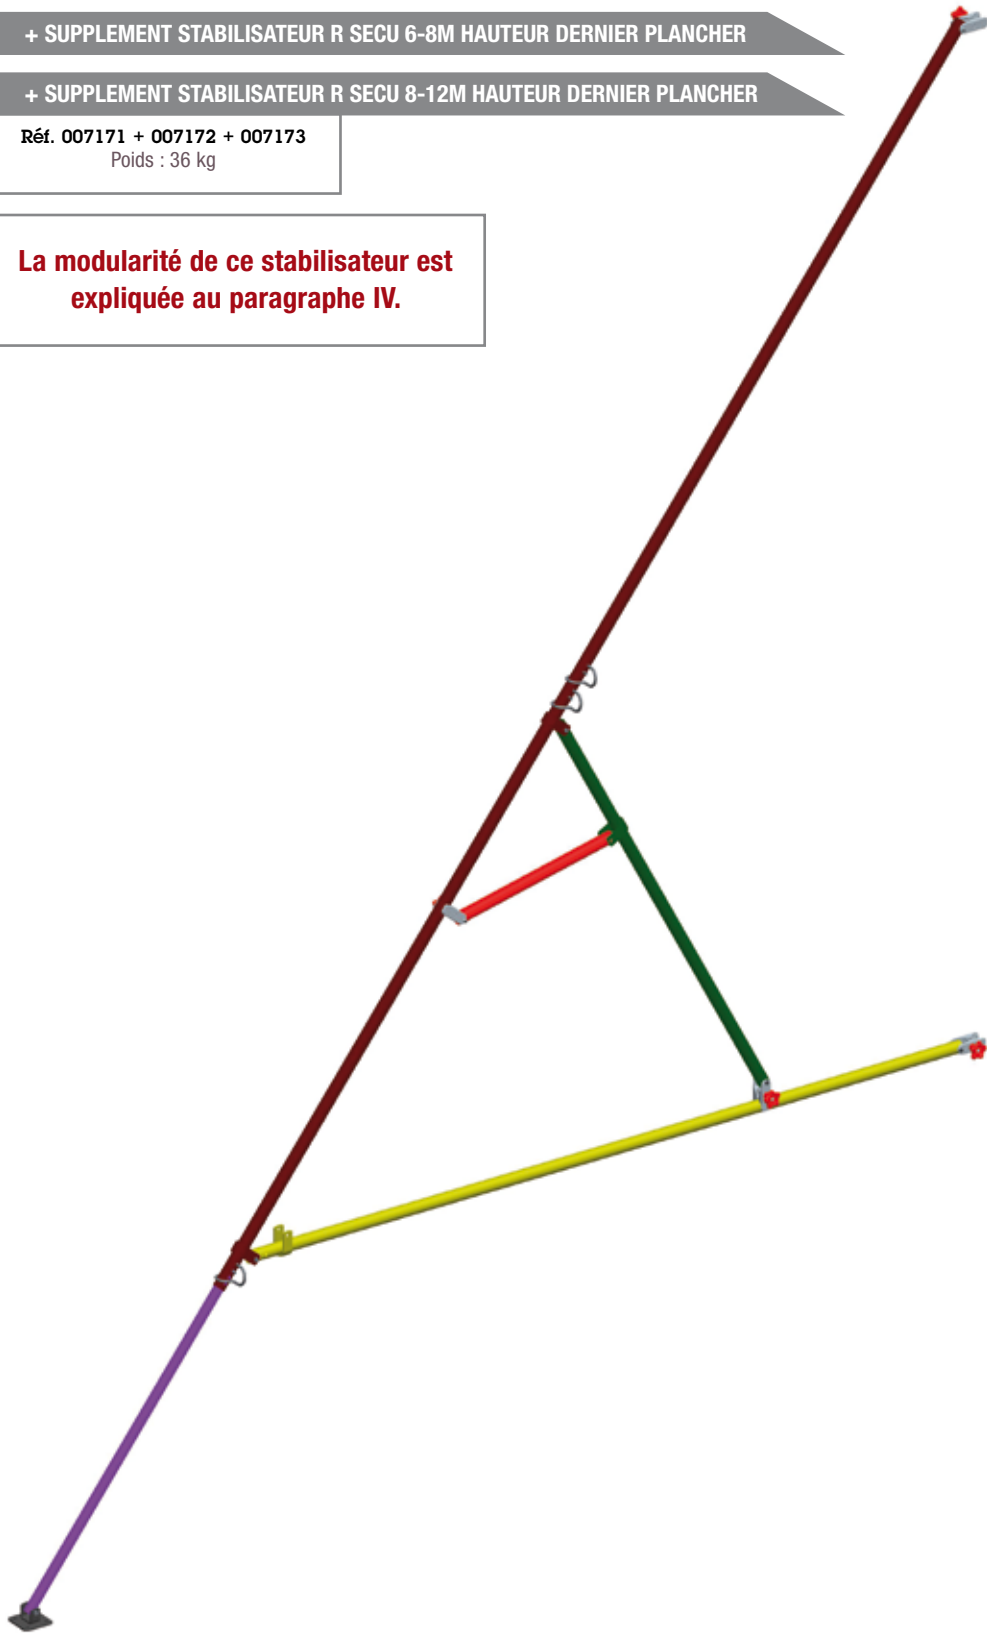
Stabilisateur R SECU 8-12m hauteur dernier plancher
